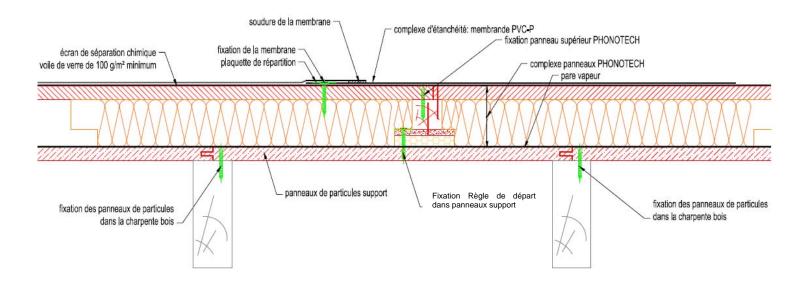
Coupe verticale sur assemblage des éléments PHONOTECH DK
